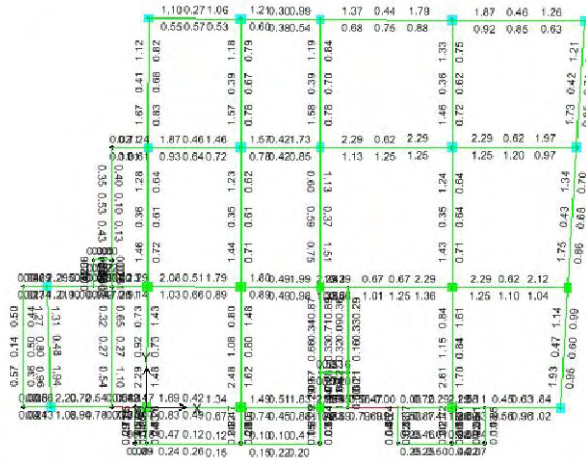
Refuerzos longitudinales en vigas – Cubierta
